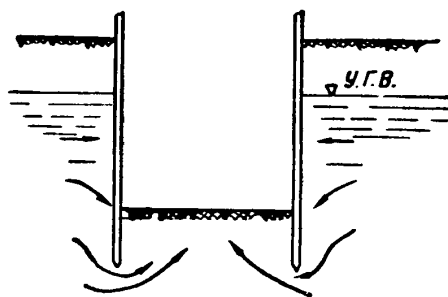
Схема движения воды в котловане при открытом водоотливе
